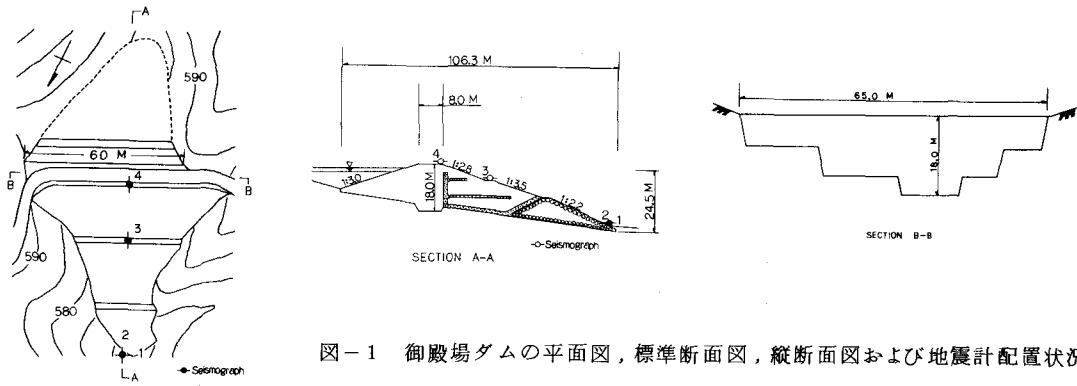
御殿場ダムの平面図、標準断面図、縦断面図および地震計配置状況
